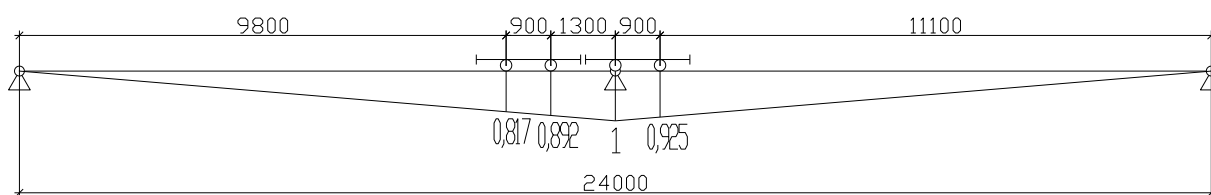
Схема определения расчетных усилий от мостовых кранов
